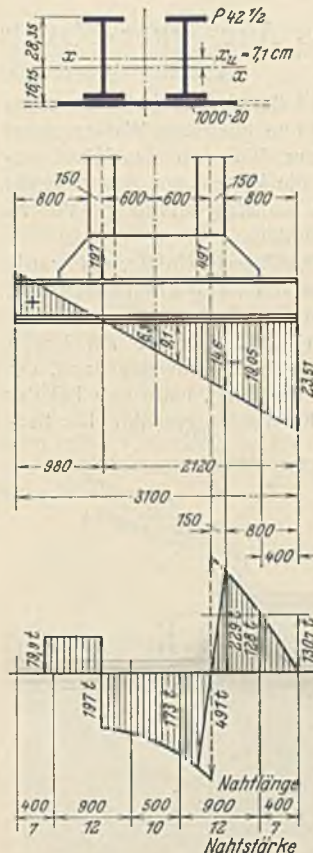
Schweißnahtberechnung der Fußplatte.
